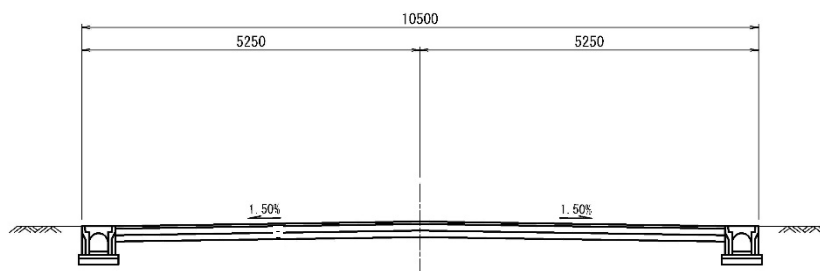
(8) 標準断面図 (特殊道路 幅員 10.5m)
